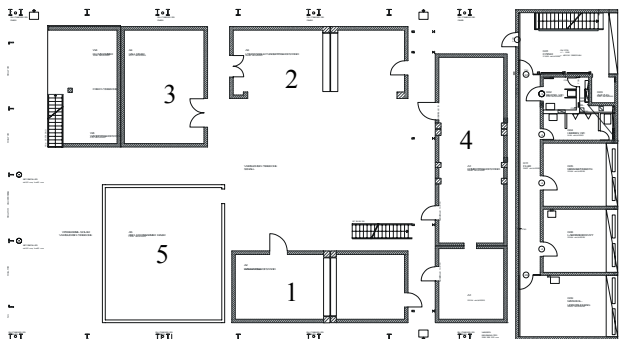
Grundriss EG des Laborgebäudes
